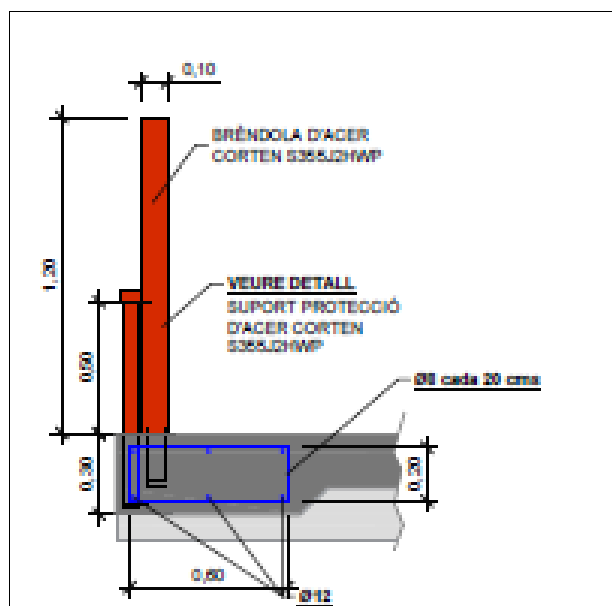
Tanca perimetral de l'actuació en el nou paviment del camí.
